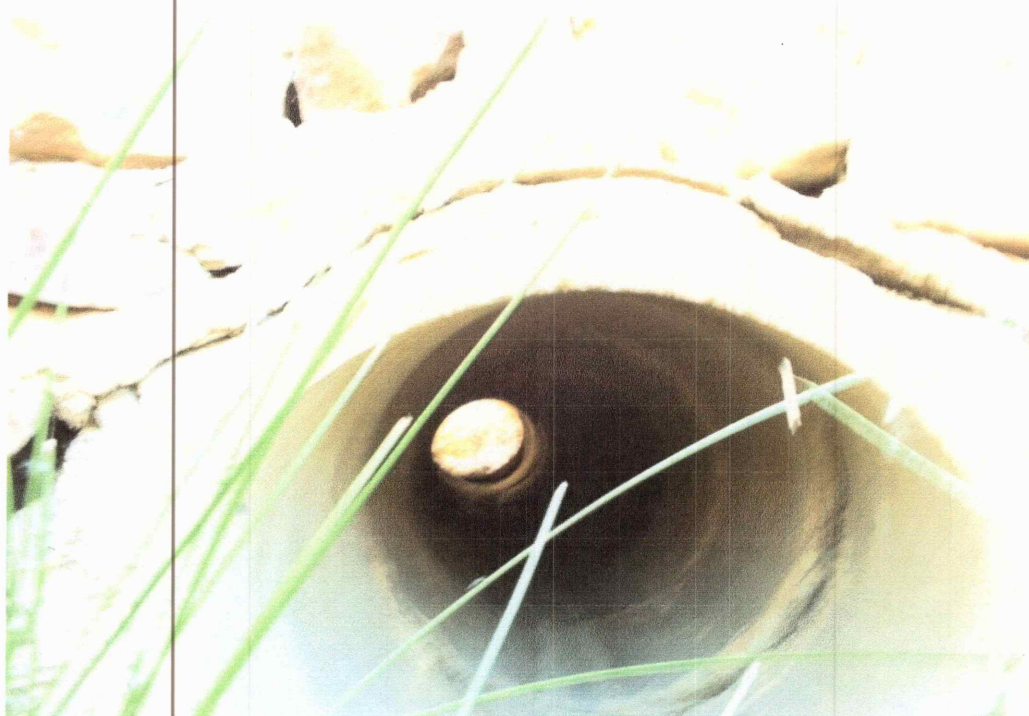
Déboitement et fissuration d'un ouvrage busé dans la zone de glissement.
